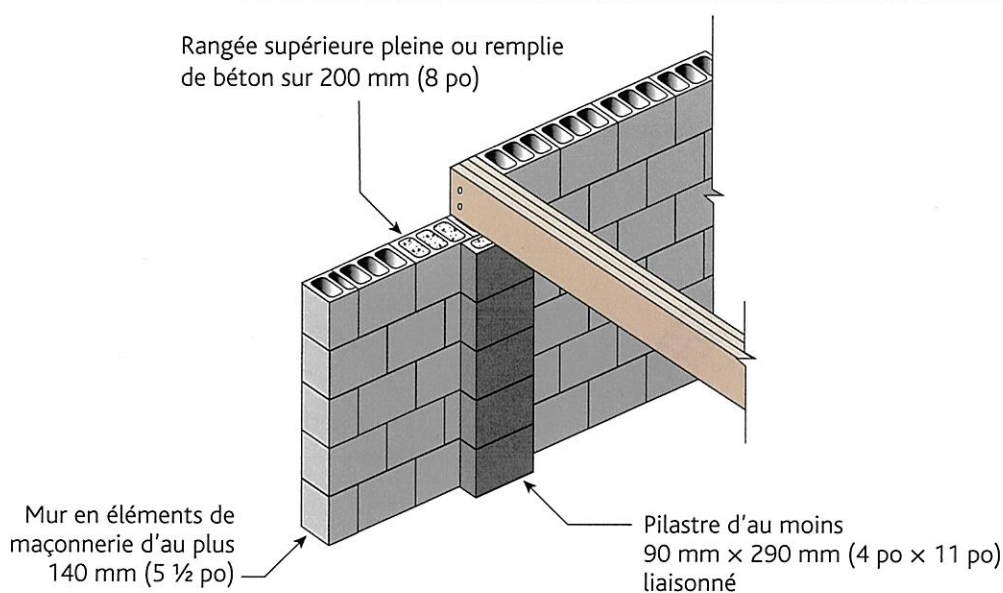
Normes relatives aux poteaux et aux pilastres
